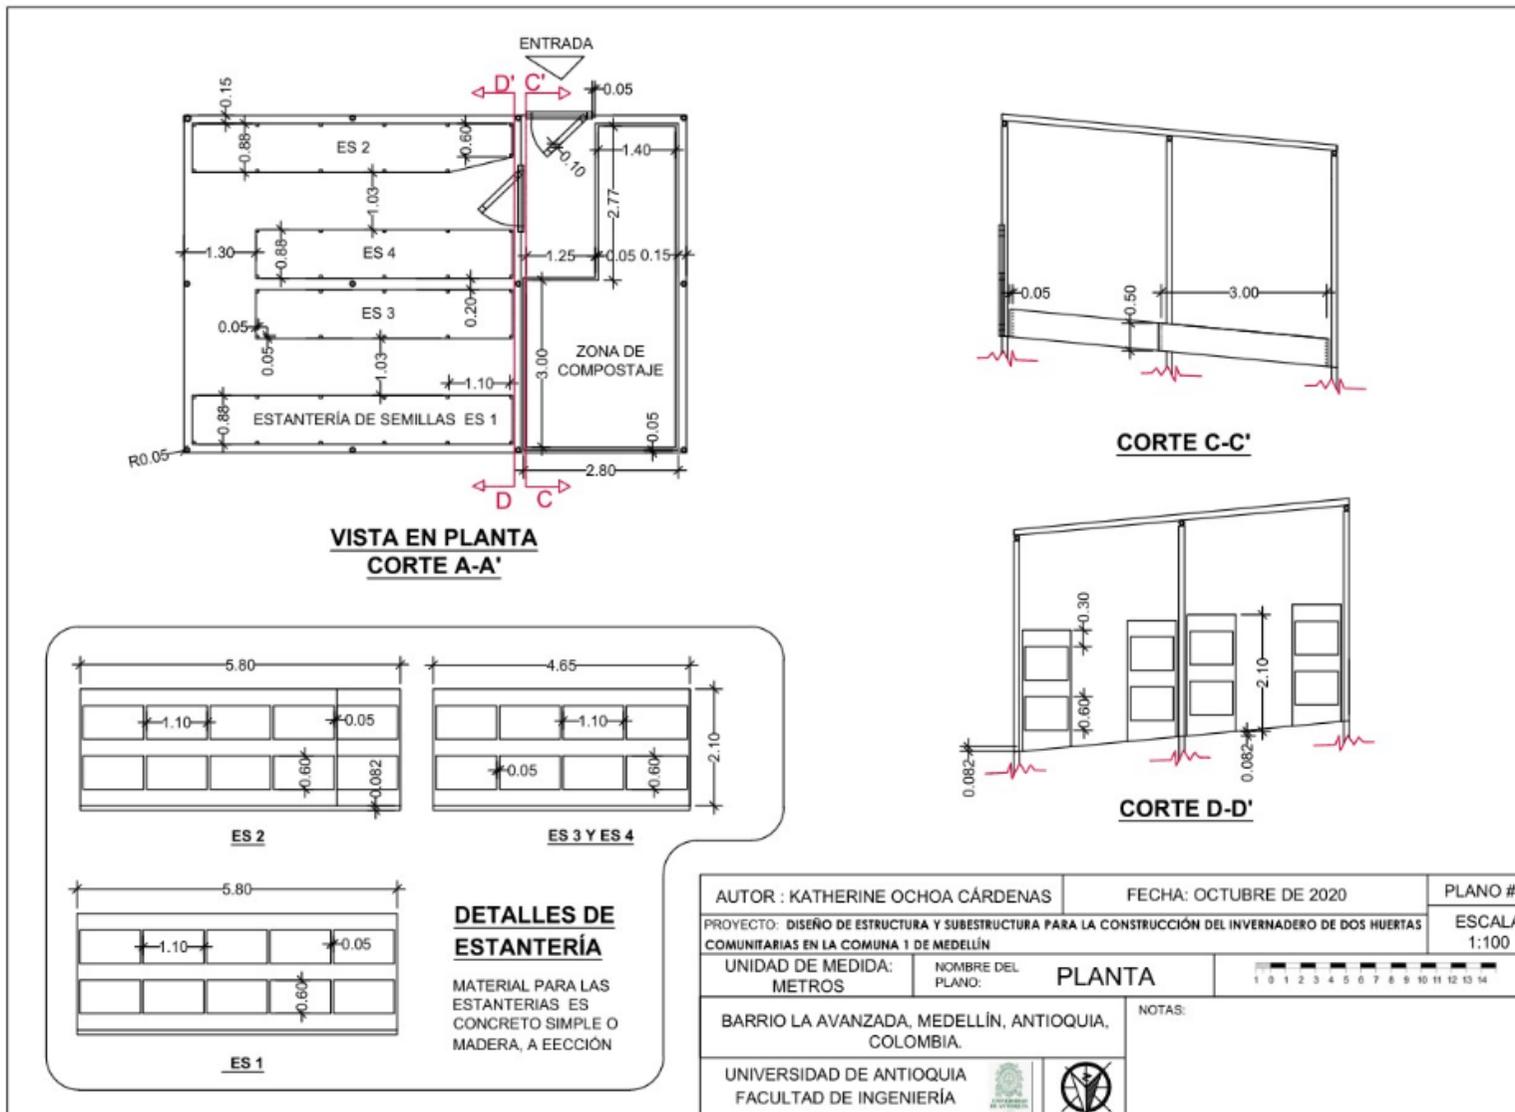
Plano #2 Planta, Barrio La Avanzada.
